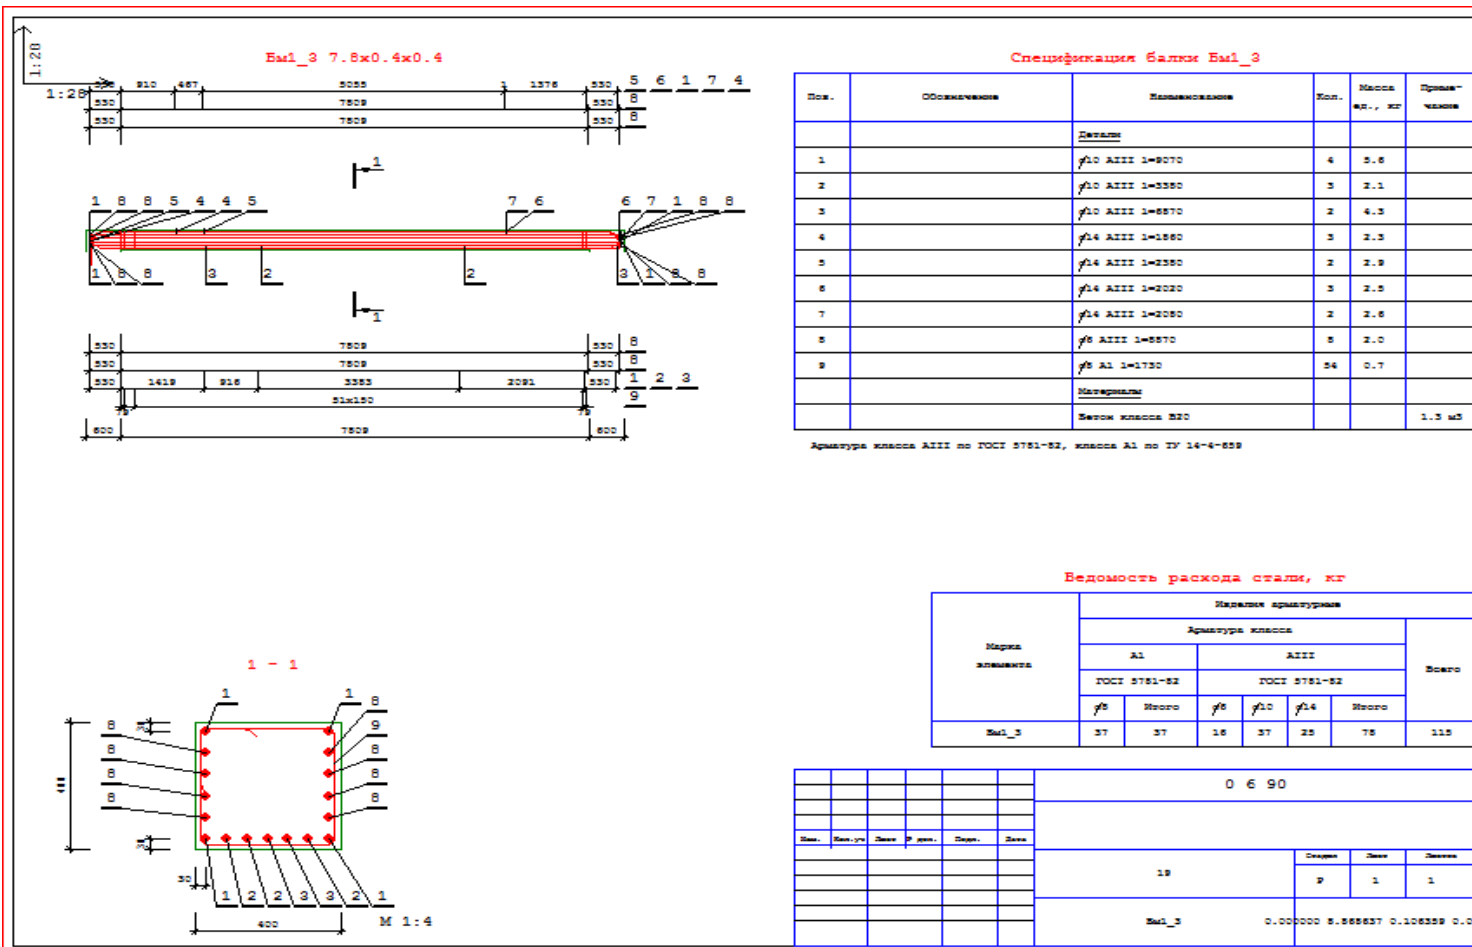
Вариант балково-плитного перекрытия. Балка 1-9-1. Креслення рабочего проекта
